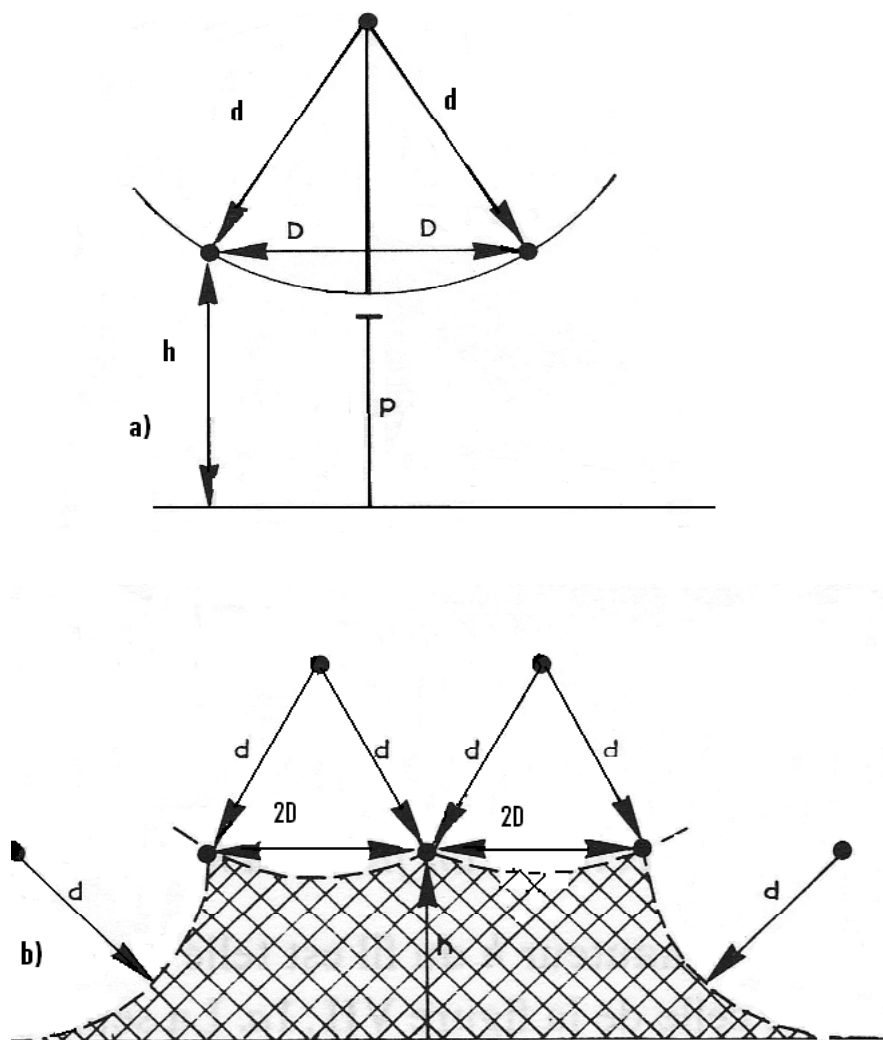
Zone de protection d'une nappe de fils horizontaux.
